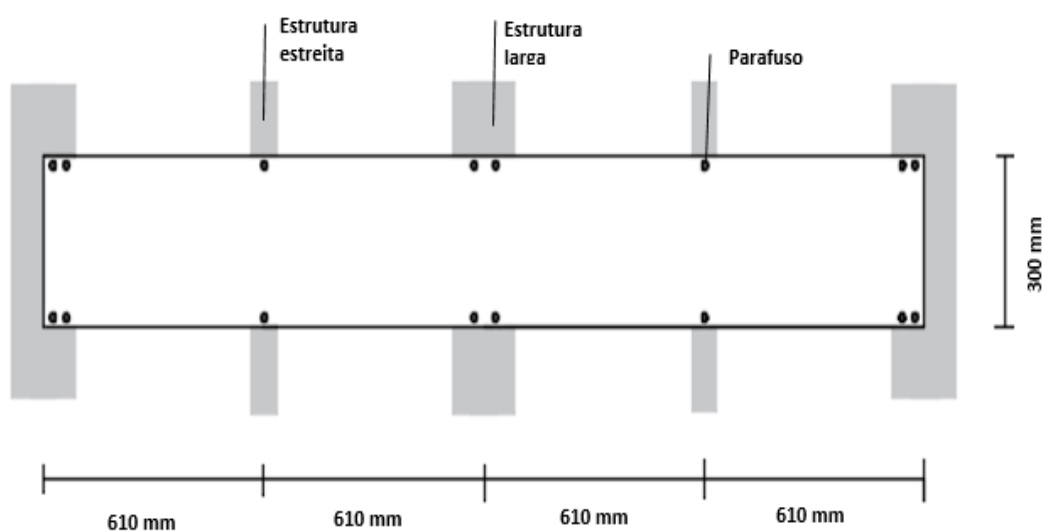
Pormenor construtivo nº 7, aplicação de painéis em bisel.
